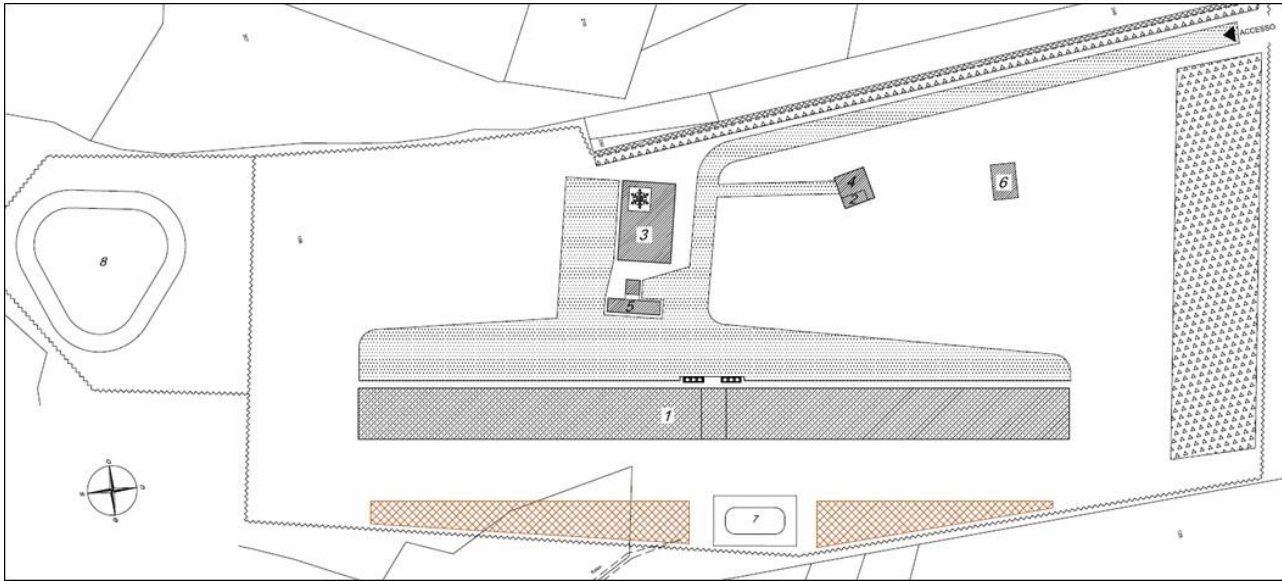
Planimetria allevamento avicolo Chiareto – Bellante (TE)
